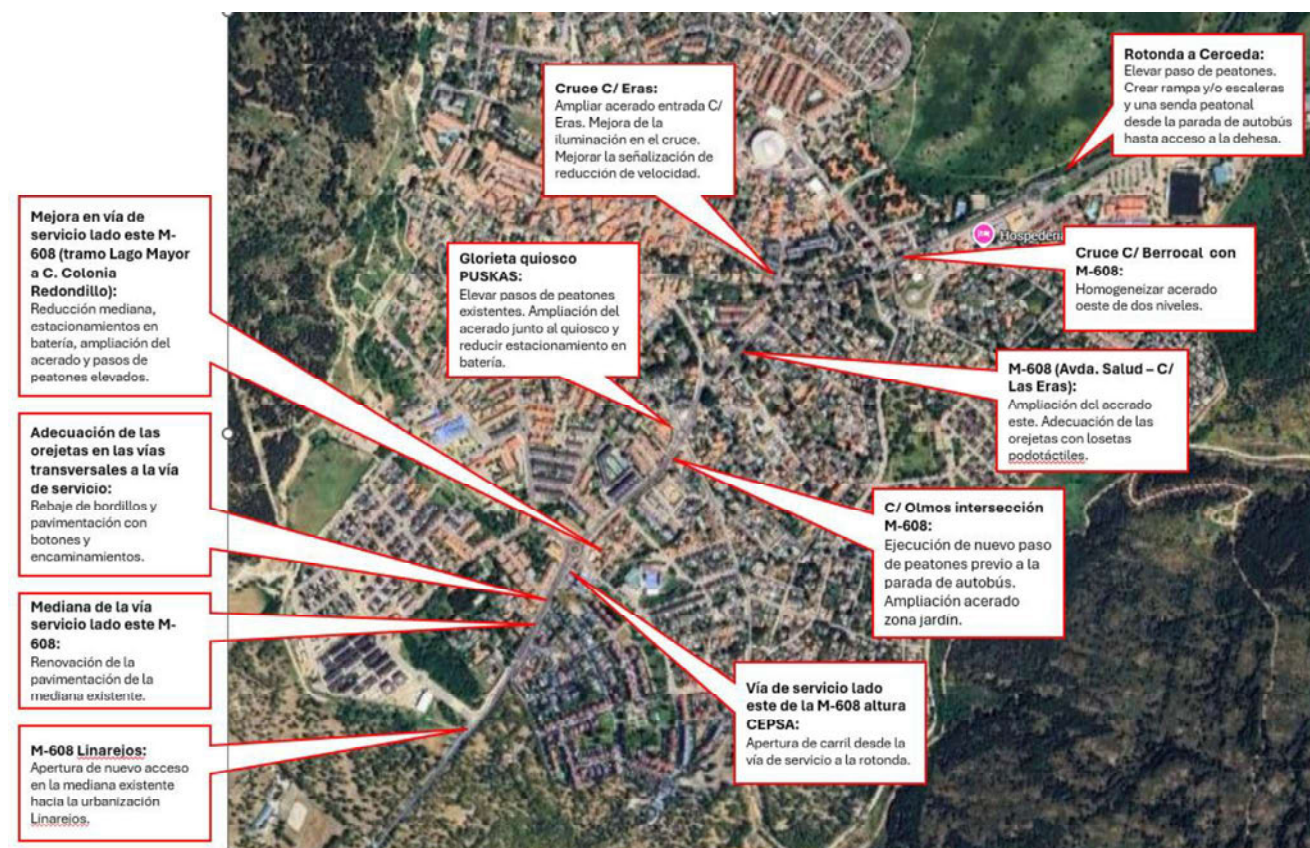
Planta del tramo de la M-608 a su paso por Moralarzal. Fuente: Plan de Carreteras 2025-2032. Avance de plan. Anexo VI: travesías
